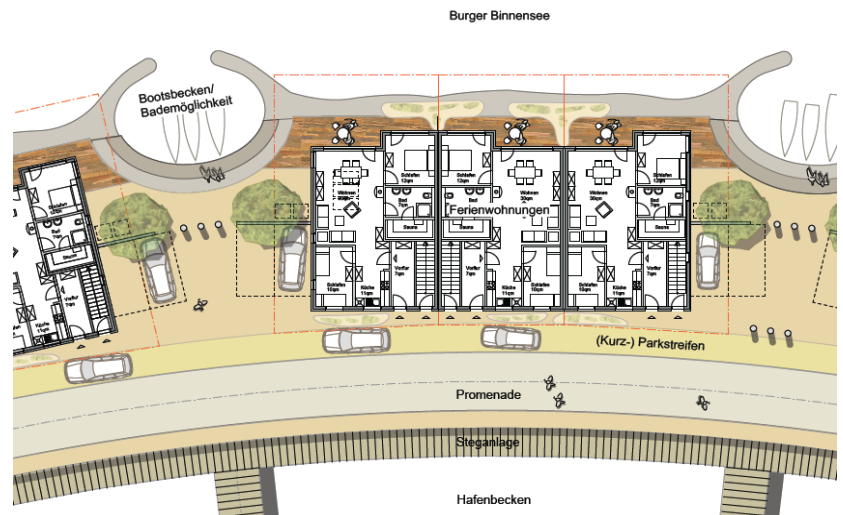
Grundrissanordnung des Vermietungskonzeptes mit 4+2 Ferienhäusern
